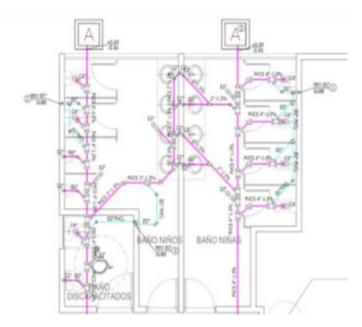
Vista en planta tuberías sanitarias y localización de las excavaciones para su ubicación.
